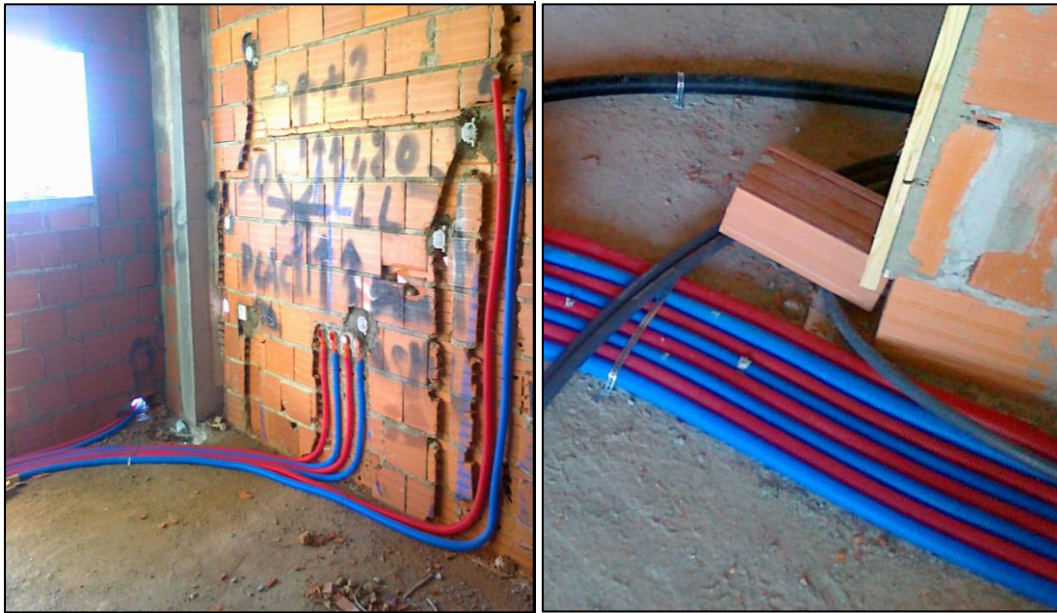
Tubagem embebida nas alvenarias e pavimento
